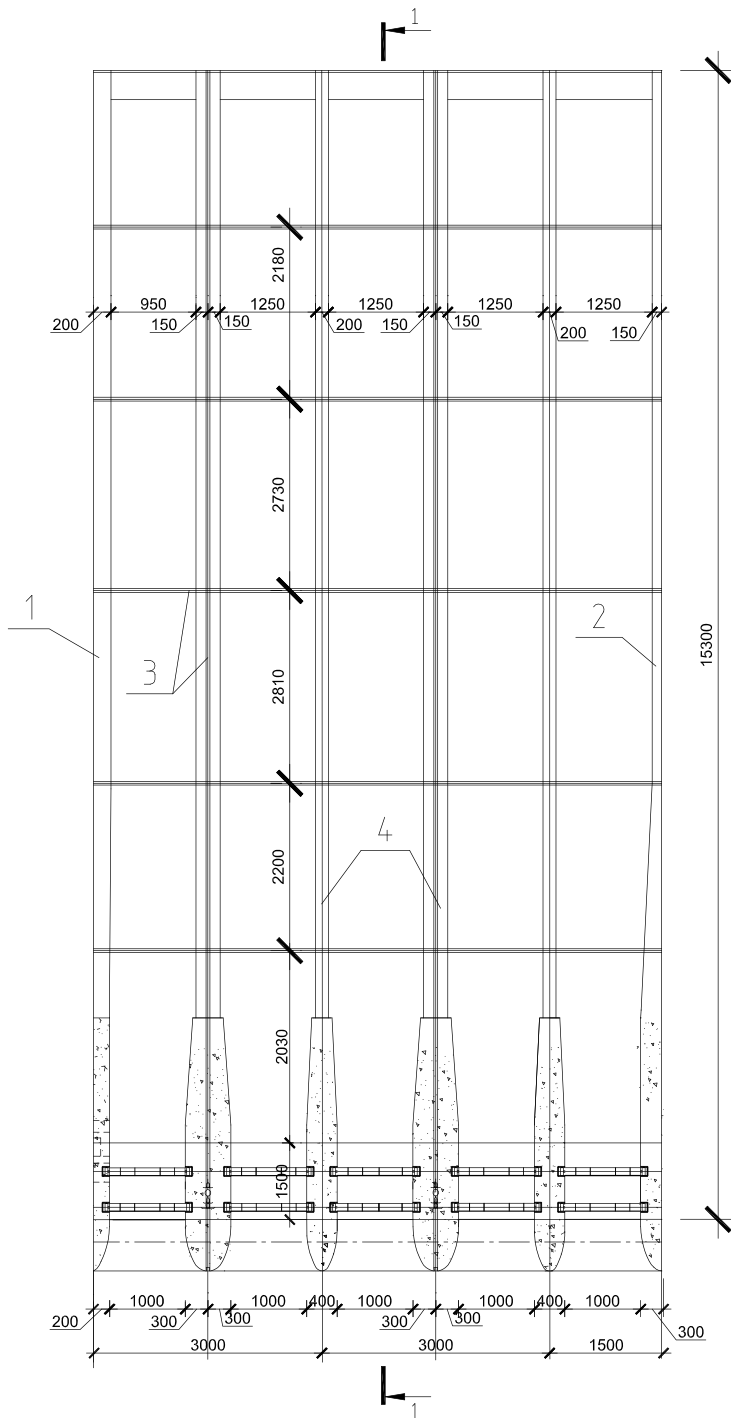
План проектного варианта водосбора №2: 1 – левобережная сопрягающая стенка; 2 – правобережная сопрягающая стенка; 3 – деформационные швы; 4 – разделительные стенки между пролетами
